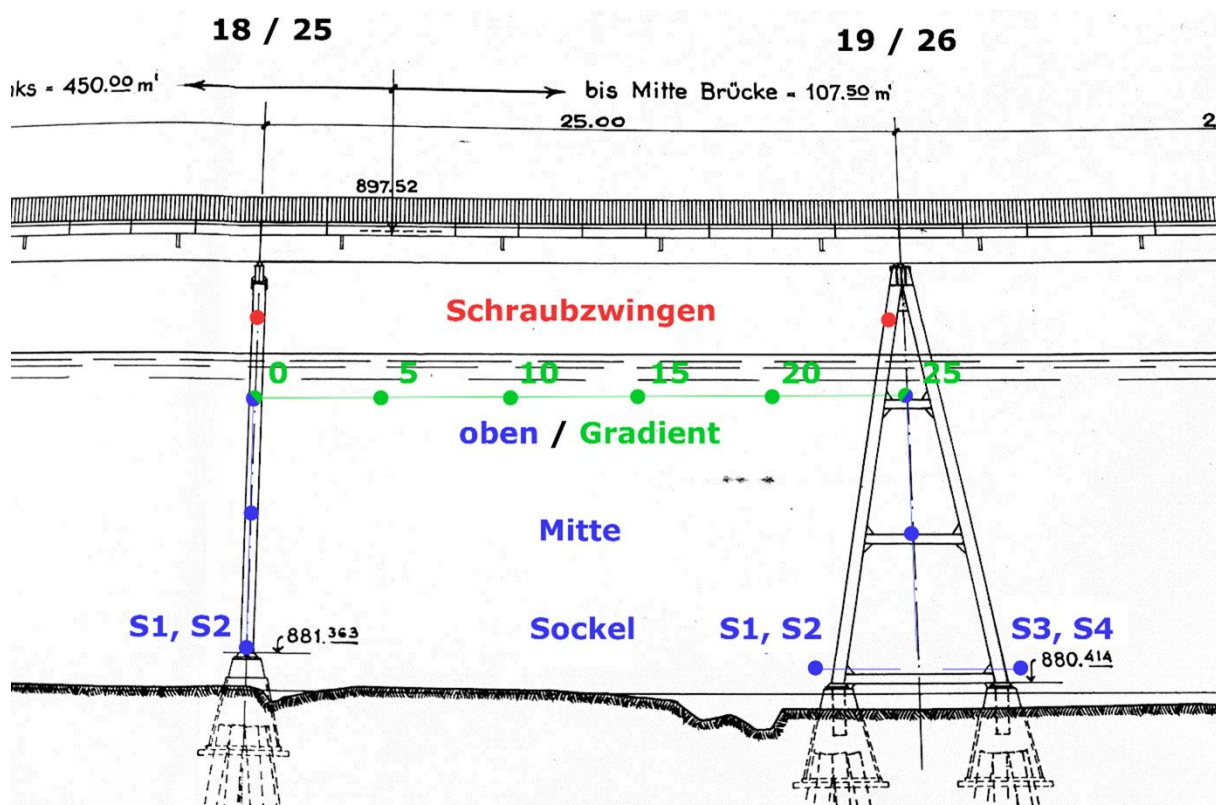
Planausschnitt mit eingezeichneten Messpunkten.
